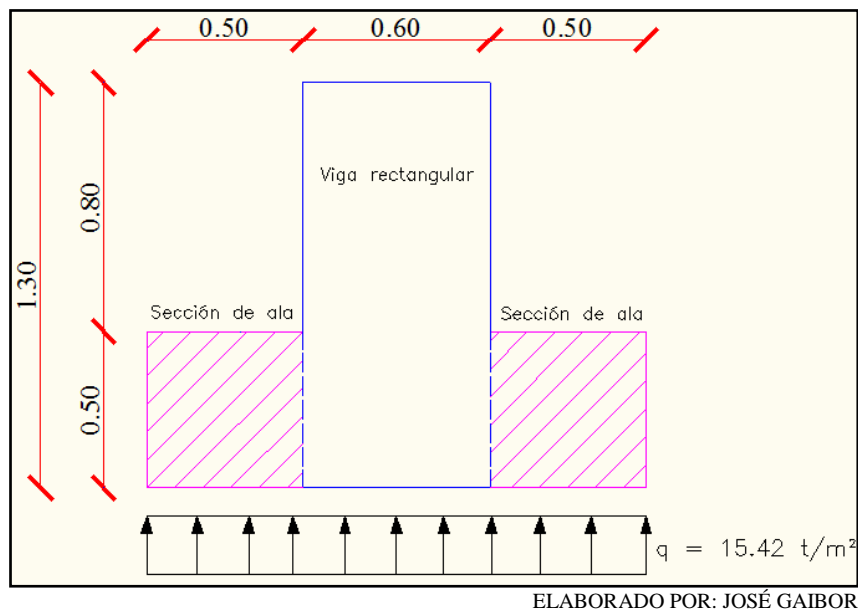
(Esfuerzo del suelo sobre la viga de cimentación)
